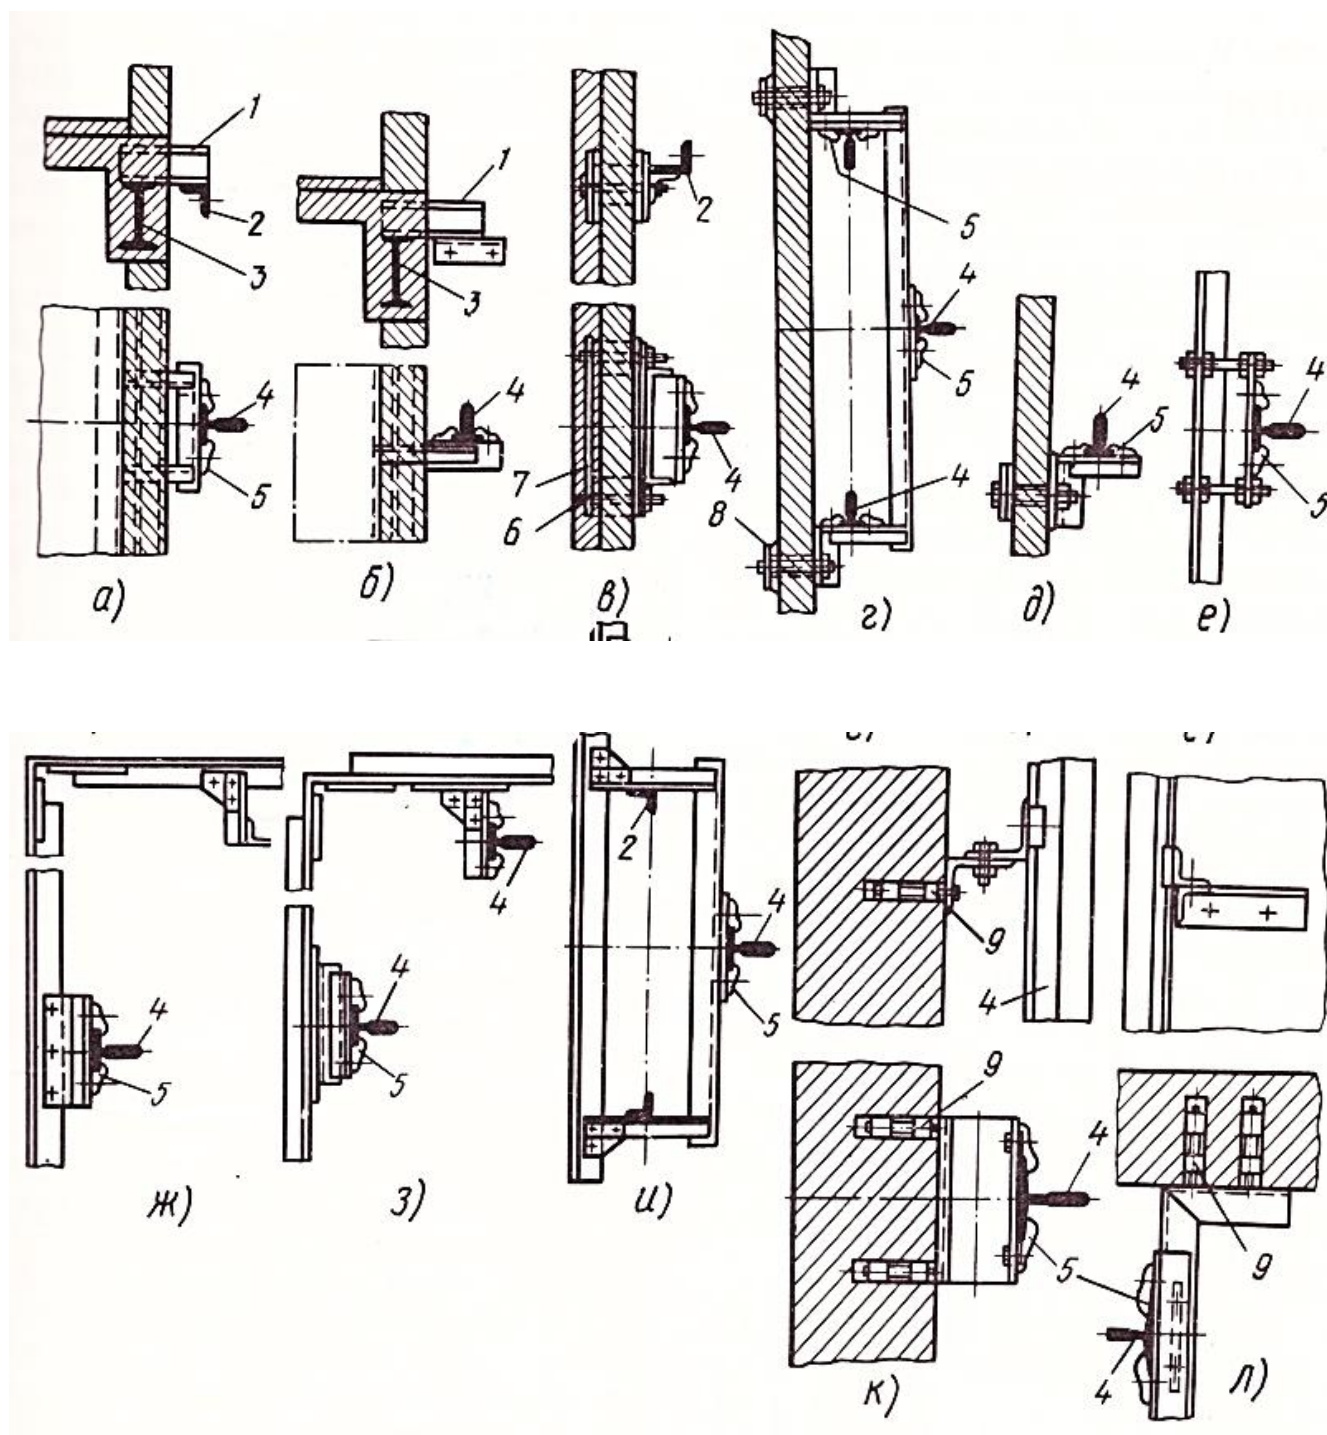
Схемы крепления направляющих кабины и противовеса к элементам шахты
